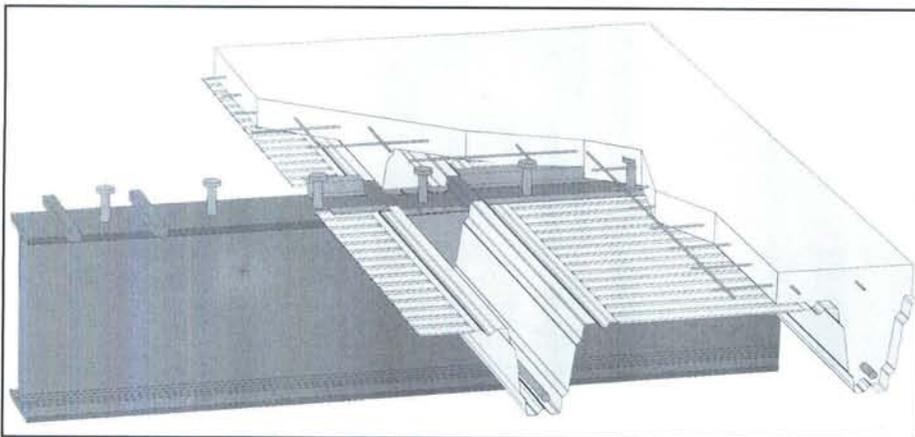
Hoesch Additiv Deckenprofil TRP 200 im Auflagerbereich
